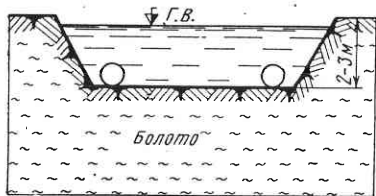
Схема укладки трубопровода в траншею — канал
